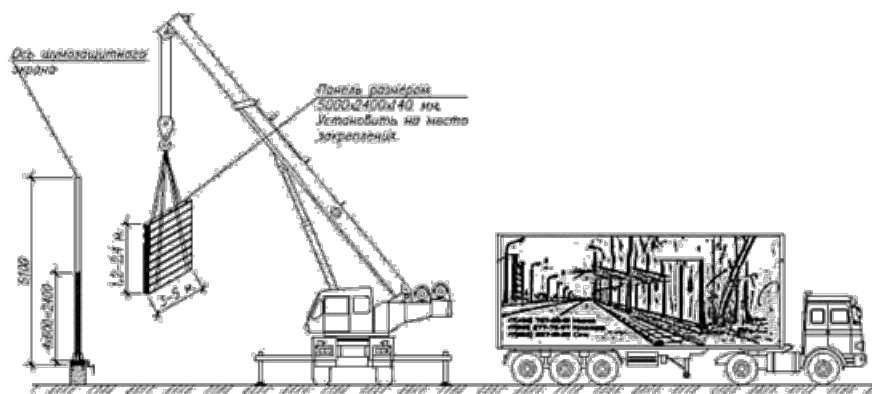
Монтаж шумопоглощающих панелей на строительной площадке
